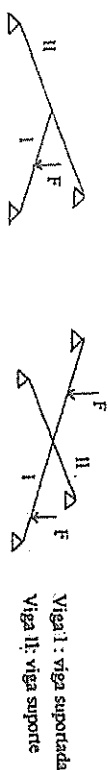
Vigas carregadas indiretamente e apoiadas indiretamente
